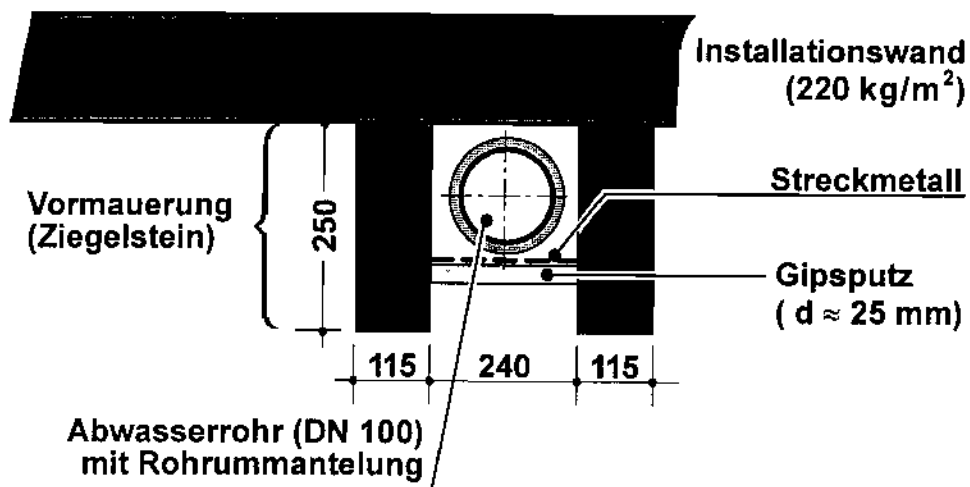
Installationsplan des Abwassersystems aus Kunststoffrohren (HT, ohne Rohrschellen) mit dem Körperschalldämmsystem "Tubolit AR Fonowave" der Firma ARMACELL (alle Maße in mm).
